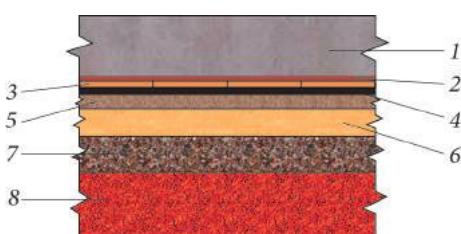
Утепление фундаментной плиты: 1 — фундаментная плита; 2 — полиэтиленовая пленка; 3 — XPS плиты; 4 — гидроизоляционное полотно; 5 — бетонная подготовка; 6 — песчаная подготовка; 7 — гравийная отсыпка; 8 — местный грунт
